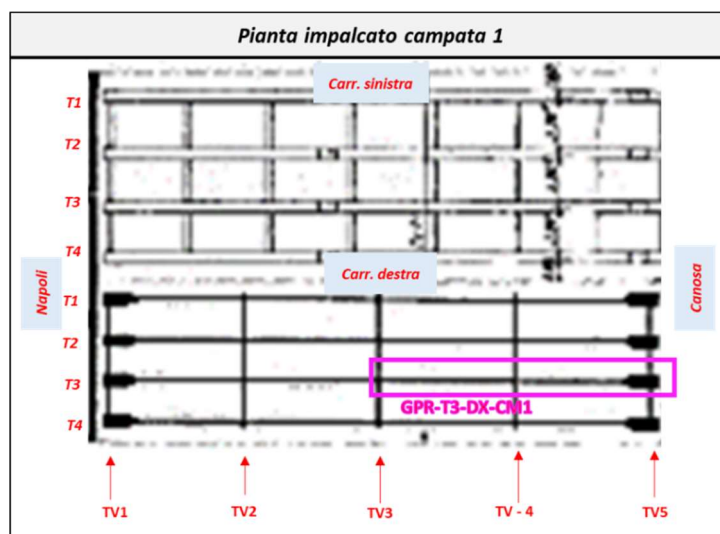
Identificazione del sistema di precompressione – Esempio ubicazione prove in pianta
